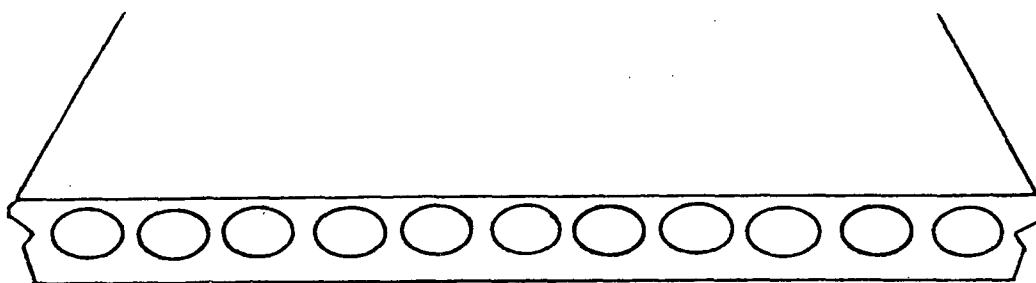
LAJE ALVEOLAR DE CONCRETO PROTENDIDO
